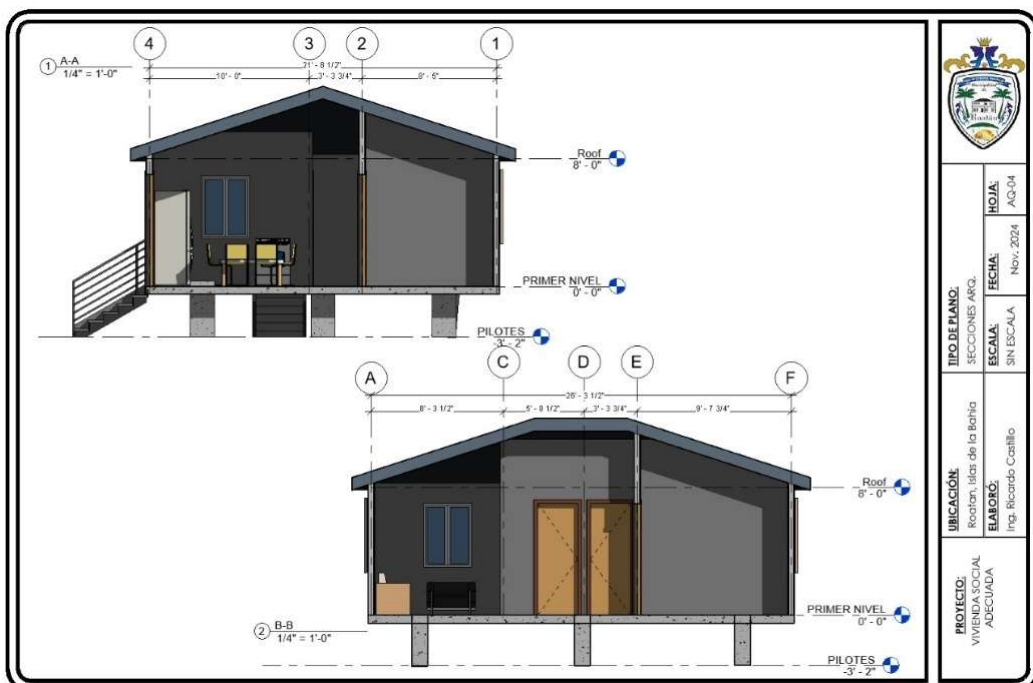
Distribución de espacios en la vivienda social propuesta
